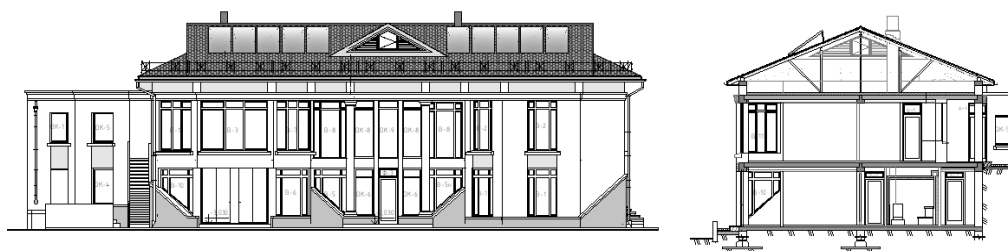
Фасад и разрез здания индивидуального жилого дома.
